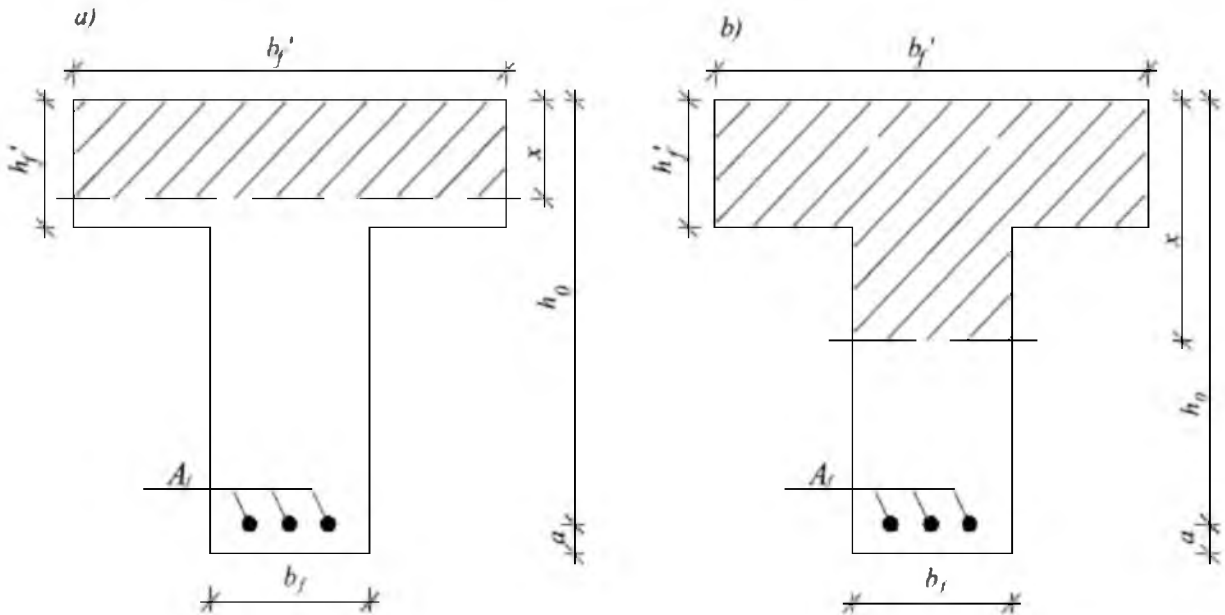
Положение границы сжатой зоны в сечении изгибаемых элементов
